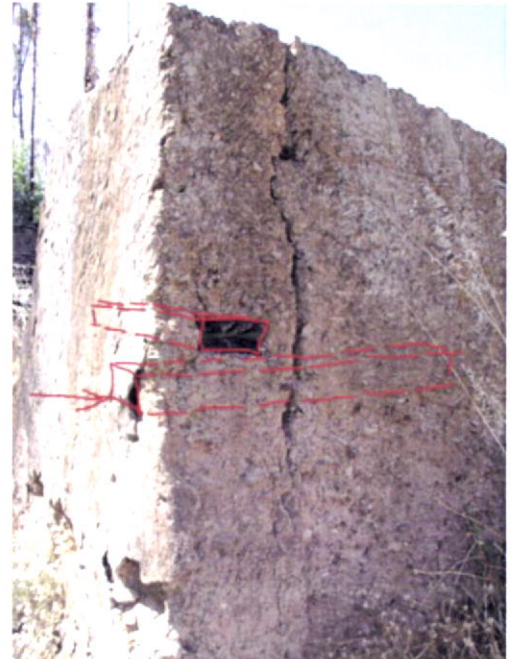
Caso de reforço de cunhais com barrotes de madeira. Note-se que as paredes encontram-se apuradas mas seriamente fissuradas no cunhal. Foz do Vale, Moinho de Baixo.
